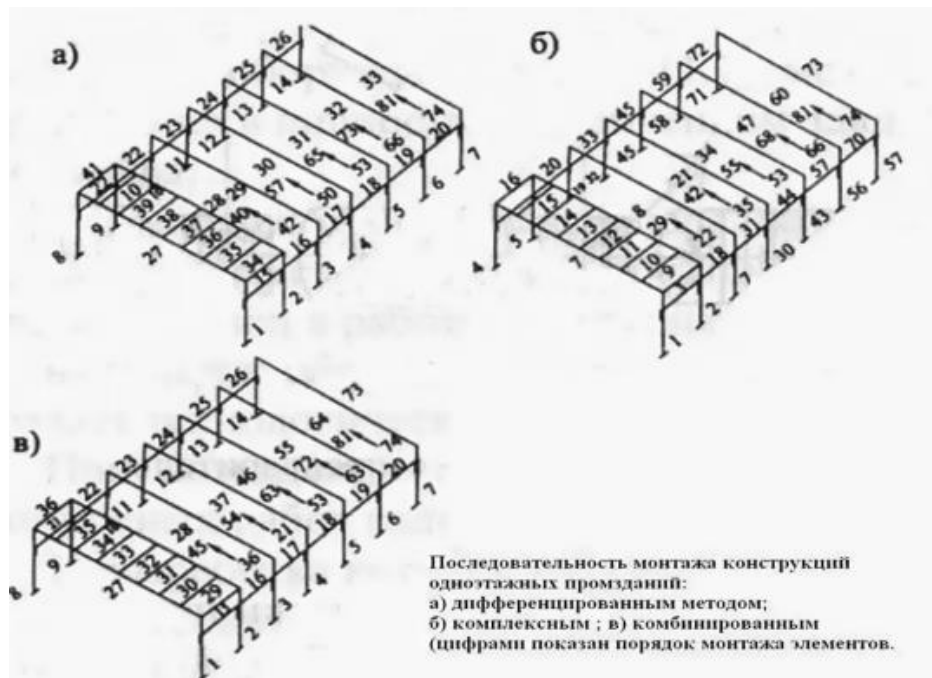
Последовательность монтажа конструкций одноэтажных зданий
